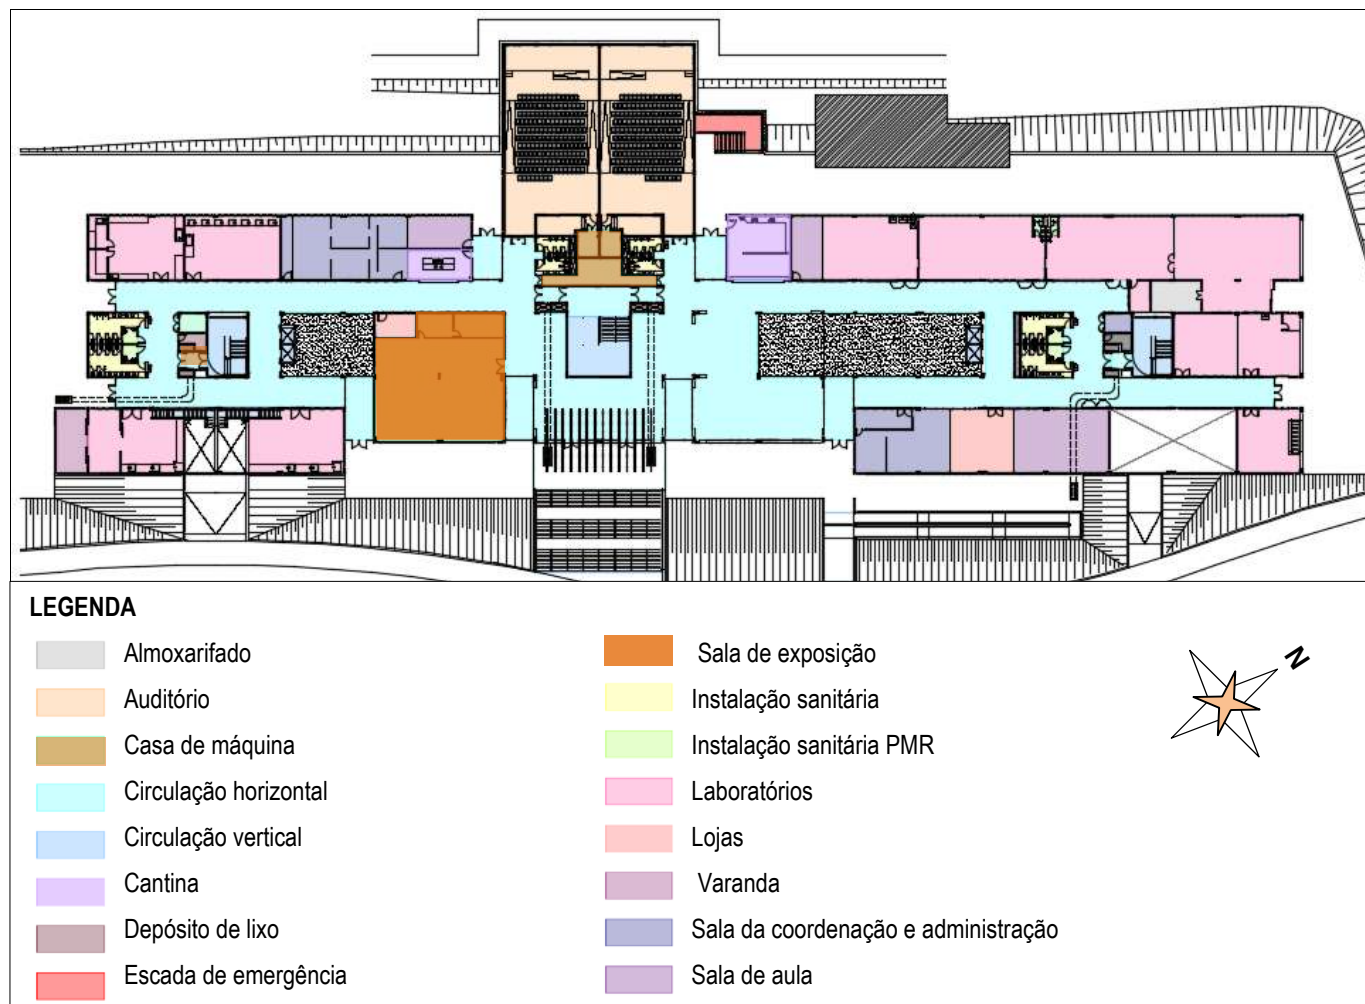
Planta setorizada pavimento térreo do bloco 04.
